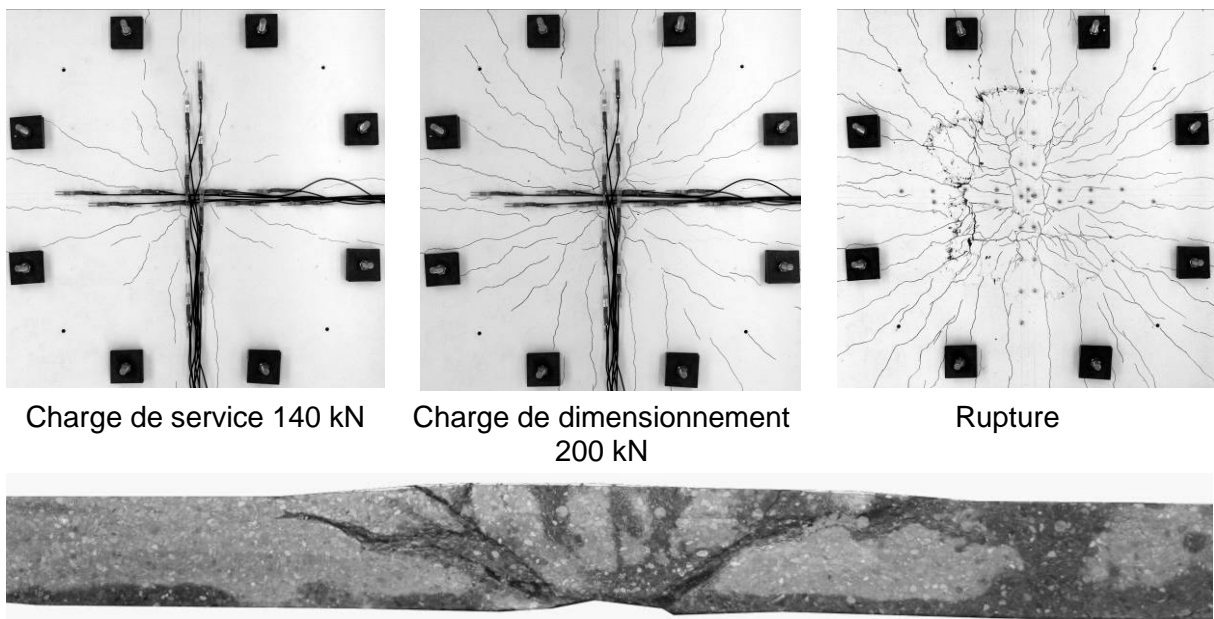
Fissuration à plusieurs niveaux de charge et fissures internes de la dalle B5-06.
